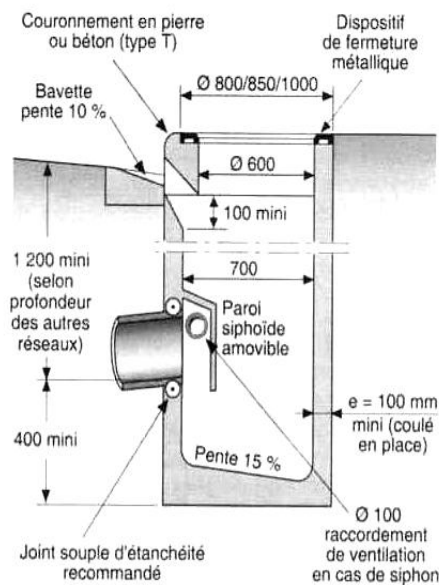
Coupe de bouche d'engouffrement à section rectangulaire de 1 m x 0,70 m, avec décantation, siphon, avec bavette et couronnement en pierre ou en béton.
